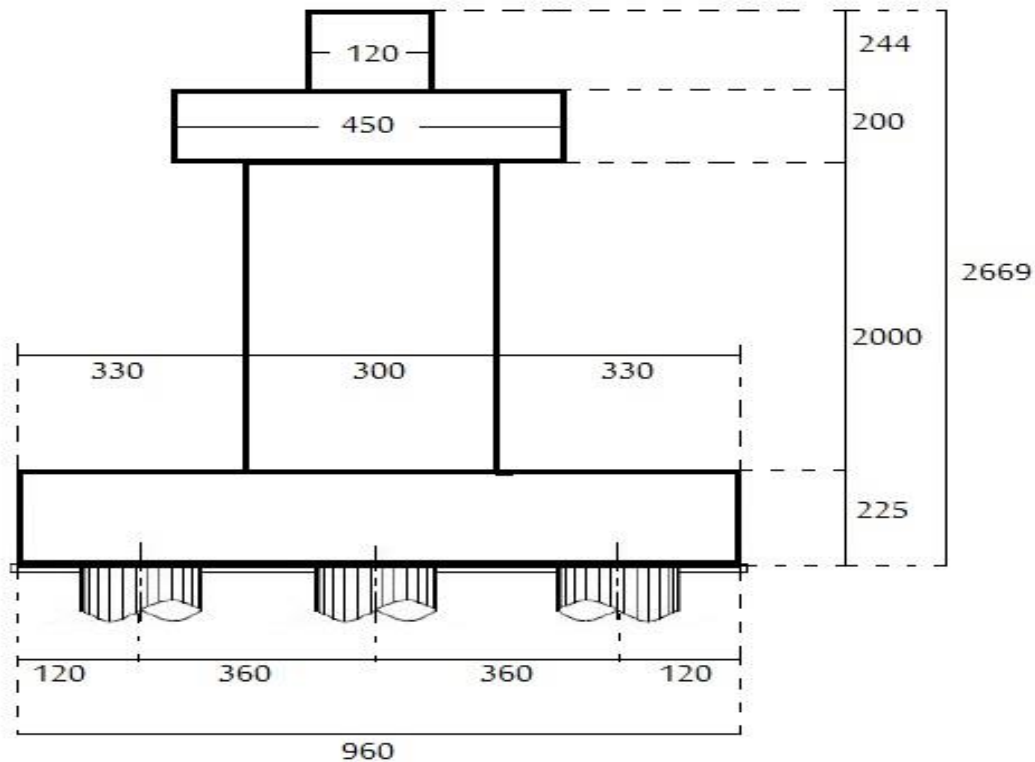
schémas et dimensionnement de la pile longitudinalement.
